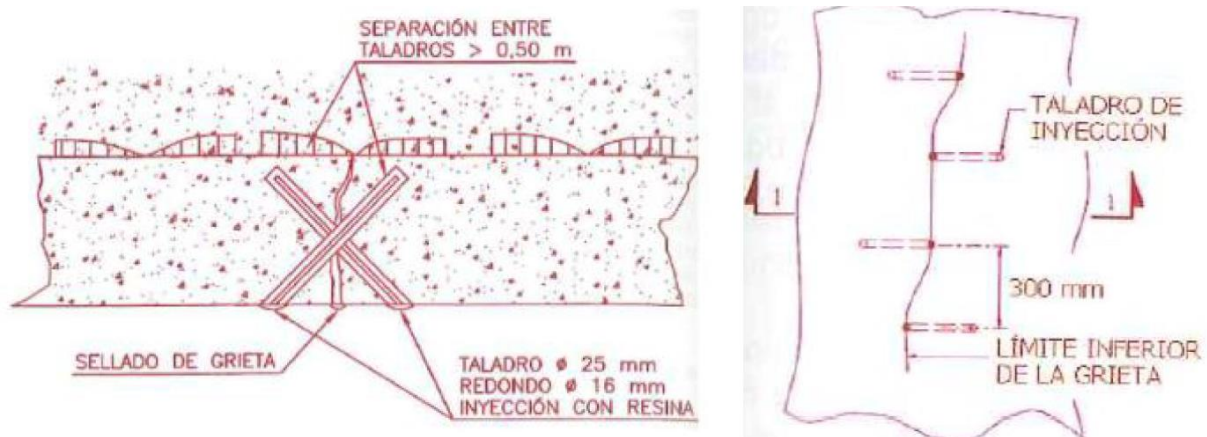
Tratamiento de fisura en elementos de hormigón en masa
